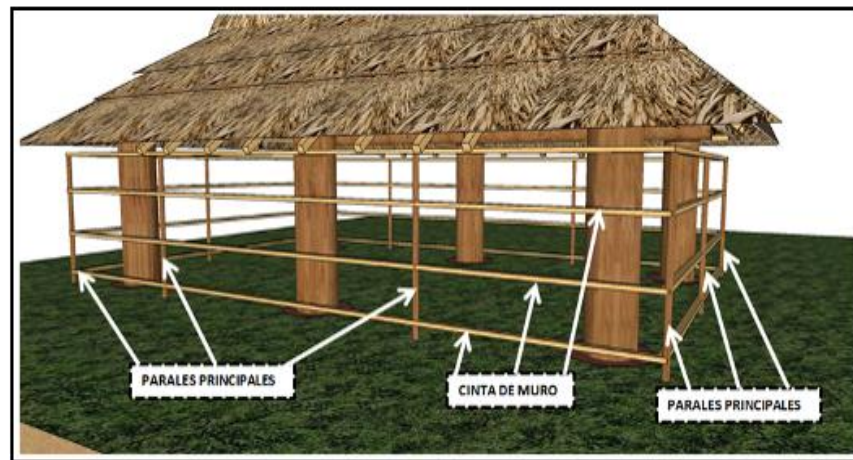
Cinta de muro y parales principales. Fuente: Cuartas (2013).
